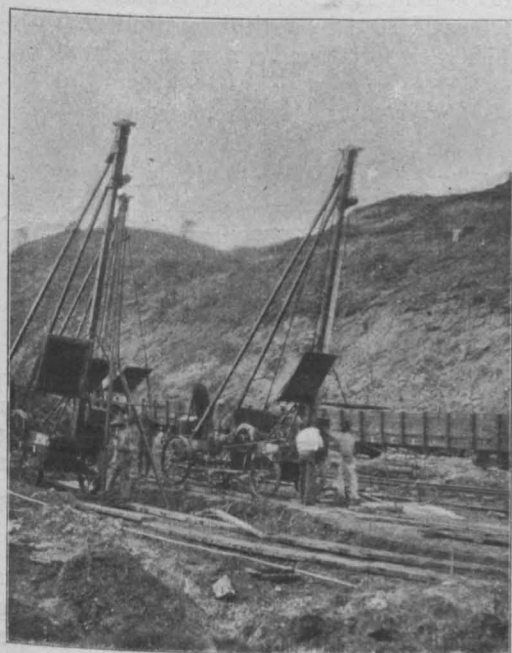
Fallbohrmaschinen im Einschnitt bei Empire
